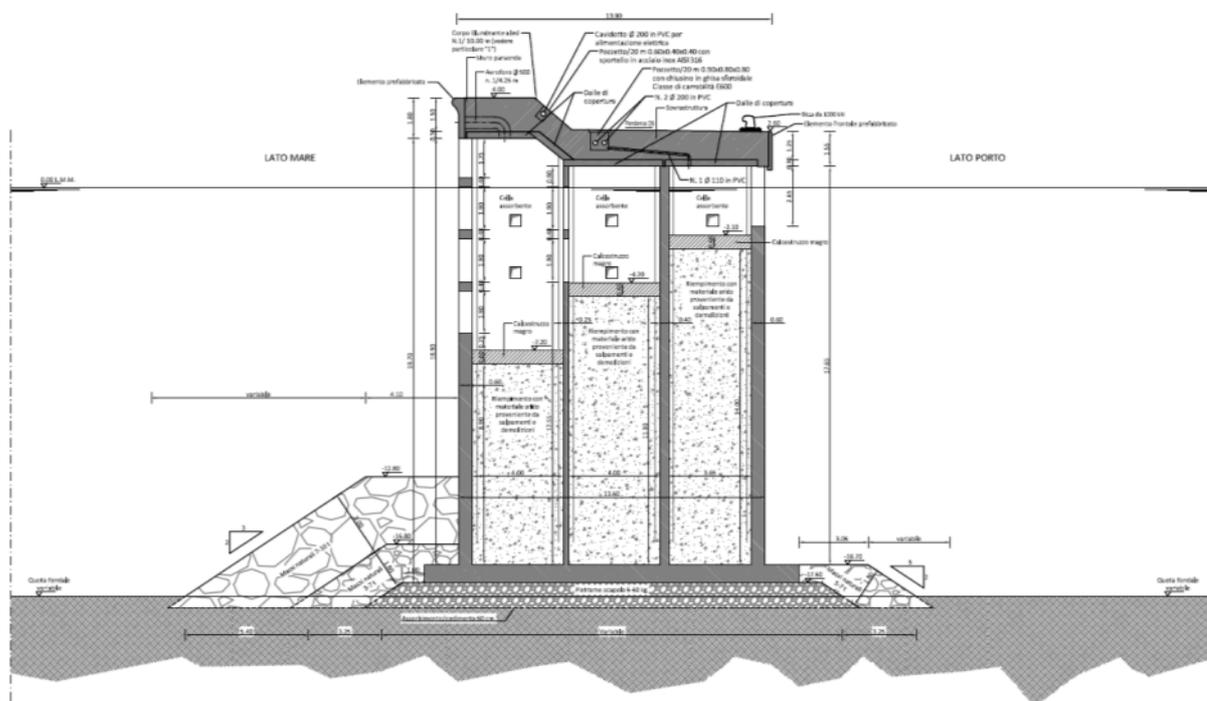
Sezione tipo prolungamento Antemurale Molo di Ponente
